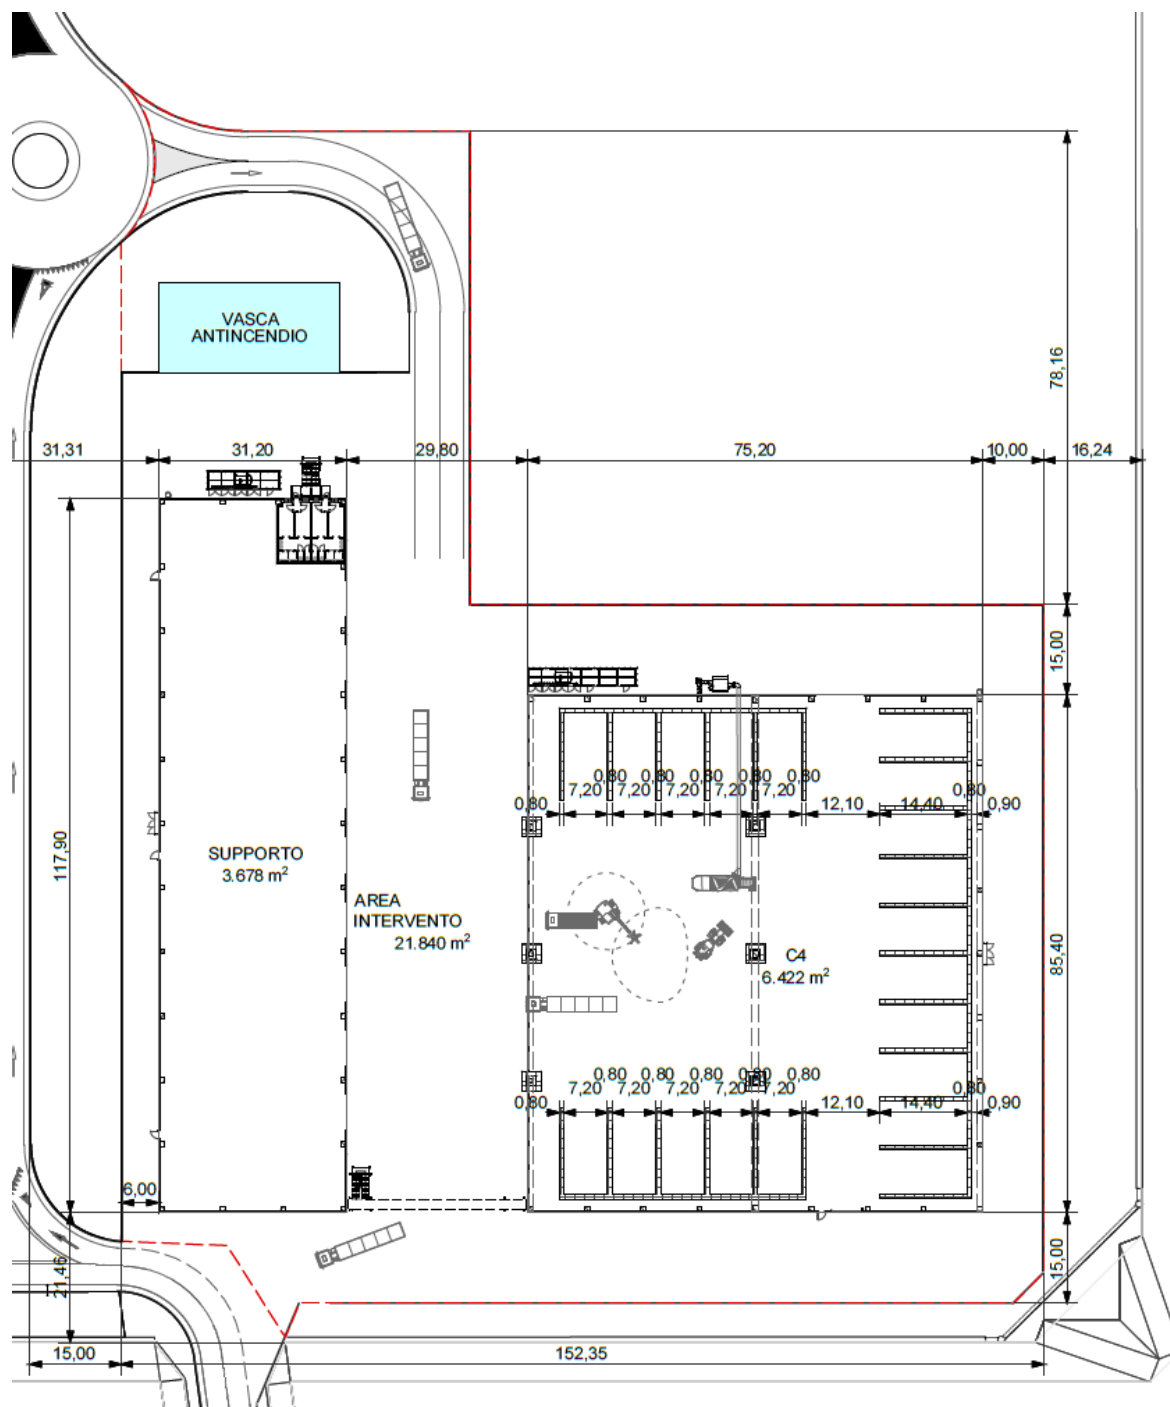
Stralcio planimetria in progetto. Il perimetro rosso individua l'area di intervento. Da doc. progettuale A.02.
